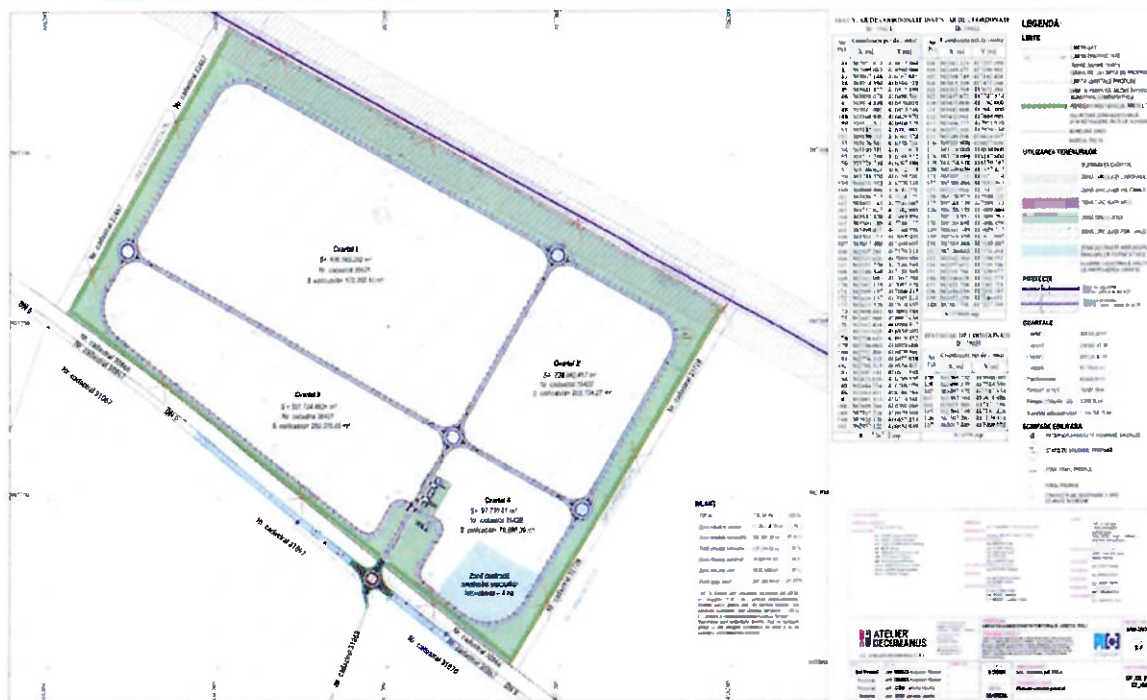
Plan de situație general al parcului industrial – organizare funcțională, cvartale, circulații și echipare edilitară (sursă: planșa SF_AR_PD_02).
